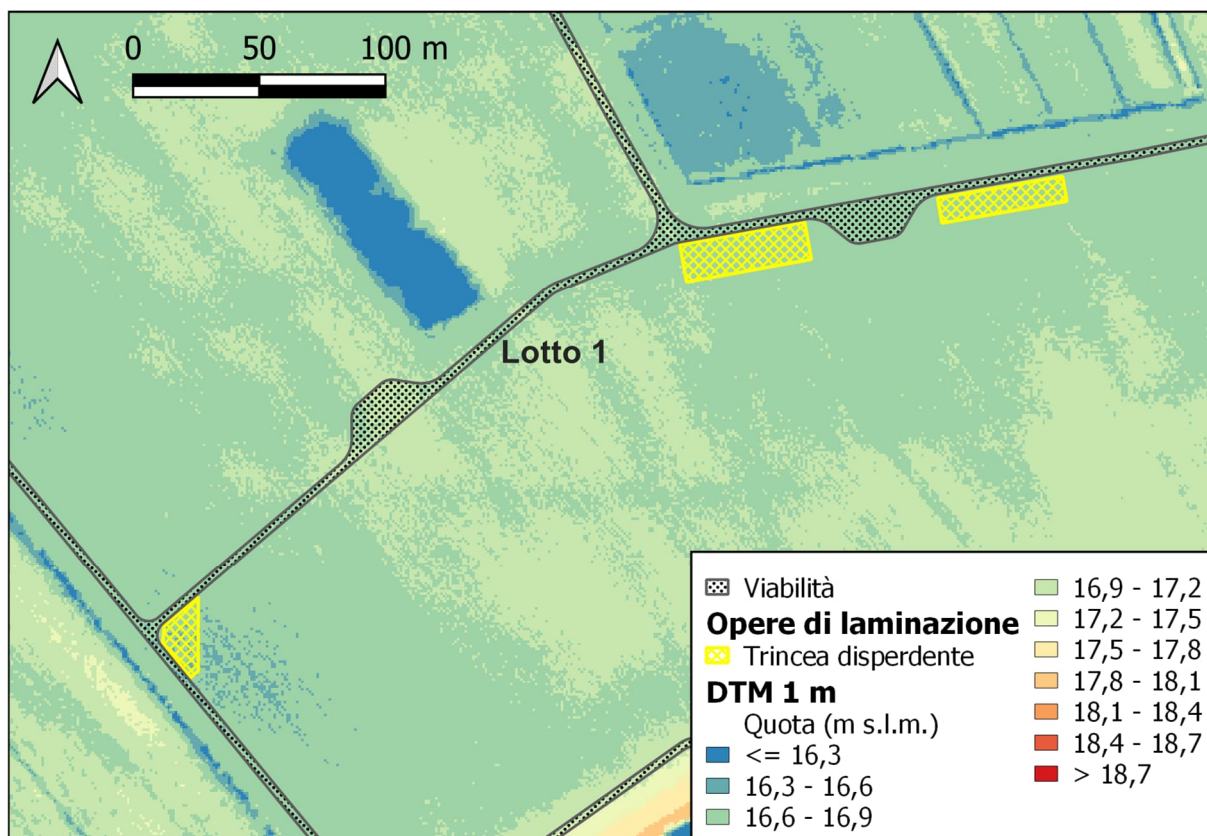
Posizionamento planimetrico delle opere di laminazione nel lotto 1.
